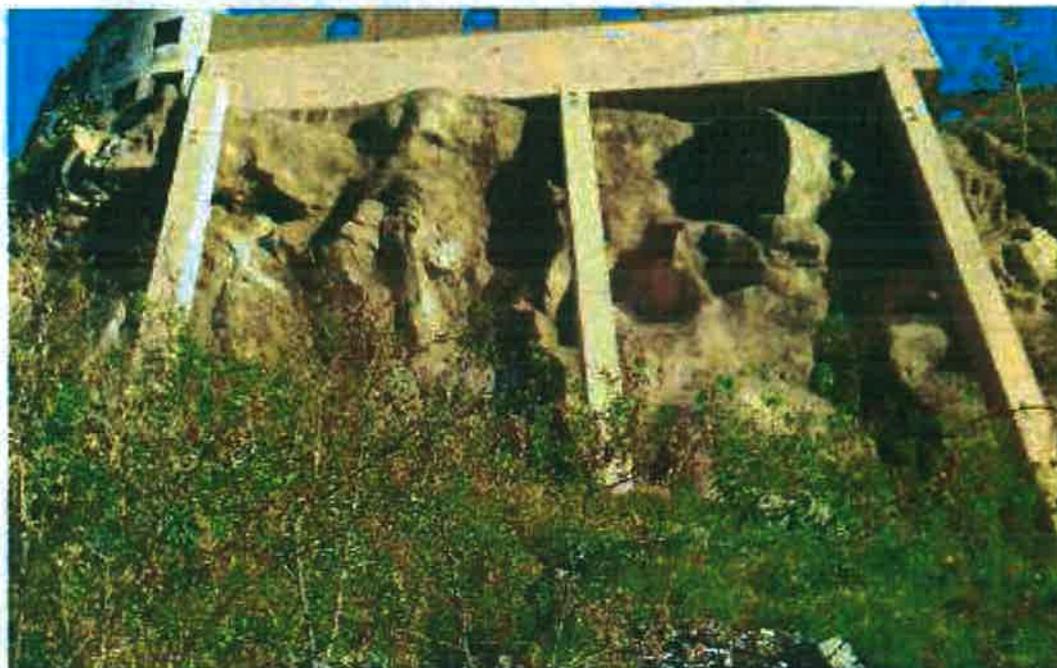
Estrutura de contenção na zona do Cemitério Judaico
